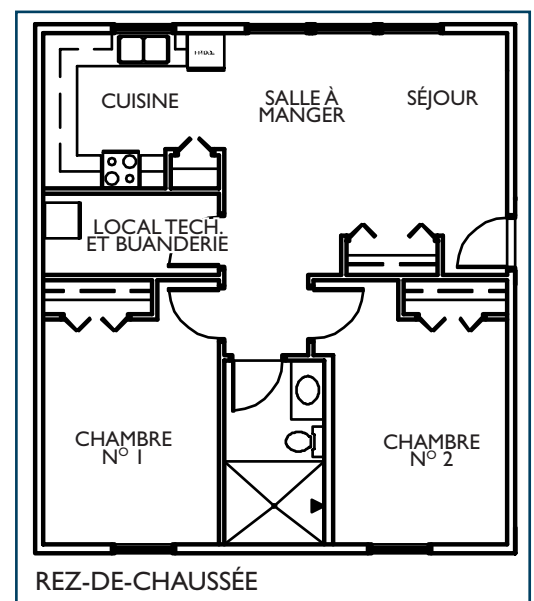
Plan d'un pavillon-jardin d'accès universel
